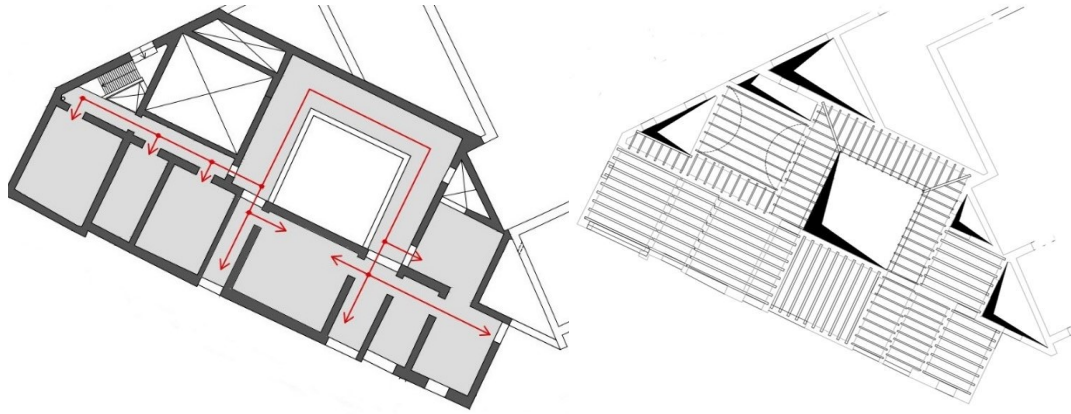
A sinistra pianta architettonica, a destra pianta strutturale (elaborazione grafica V. Centola, L. Sbrogiò).
